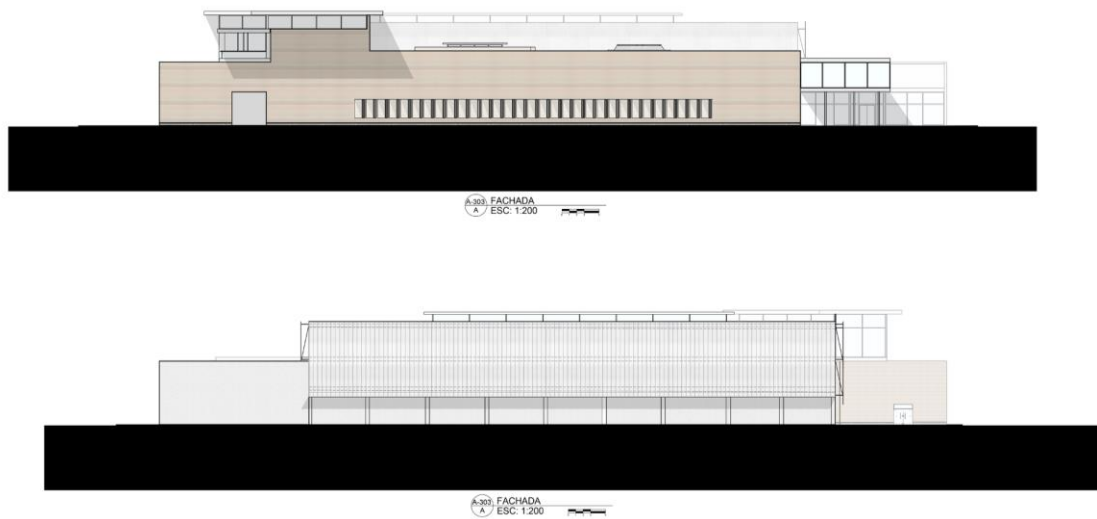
Fachadas laterales Complejo Cultural Armero. Fuente: Elaboración propia.
